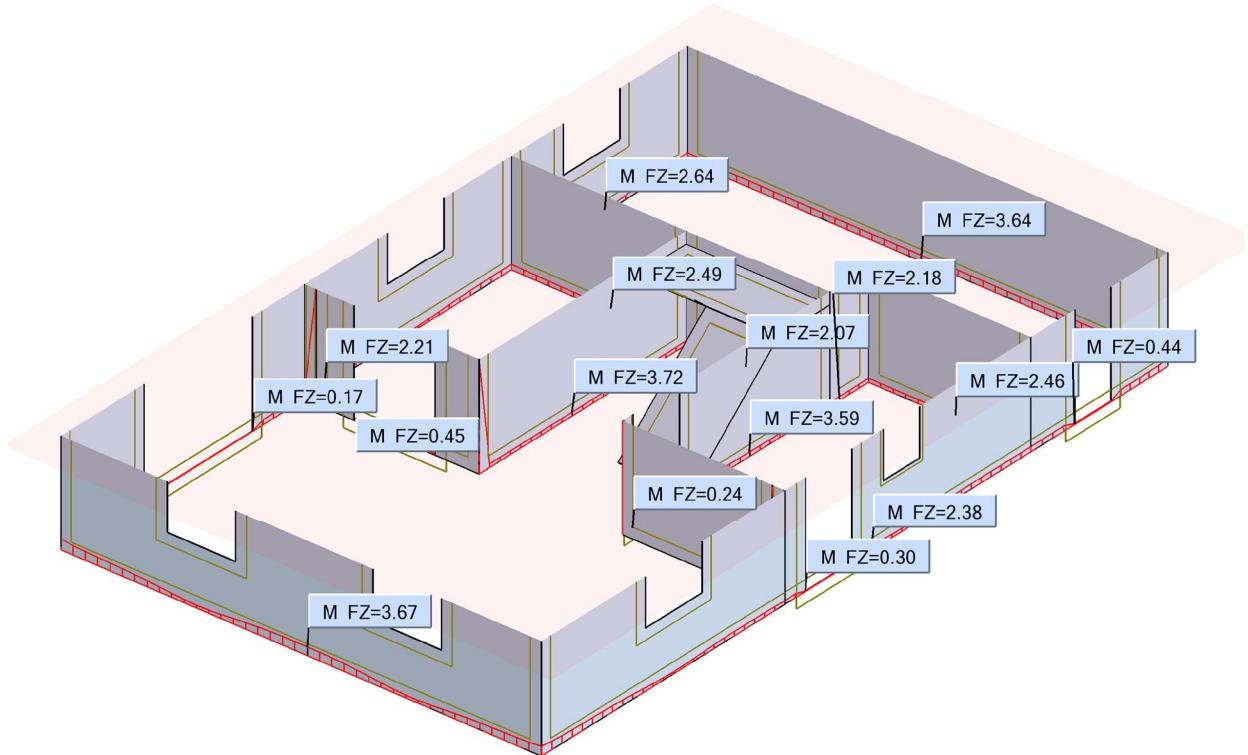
Расчетная линейная нагрузка на ленту фундамента по СОМ 1, т/м
